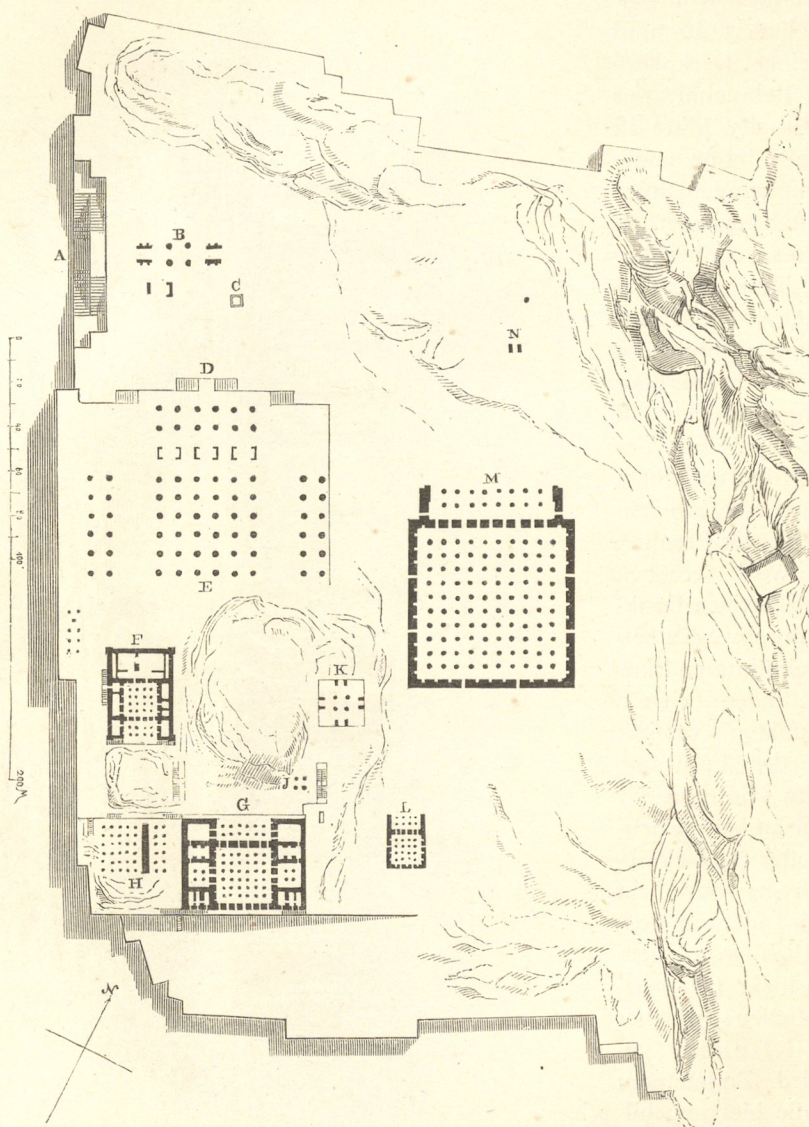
Grundriss von Persepolis. (Nach Texier und Coste-Flandin.)
